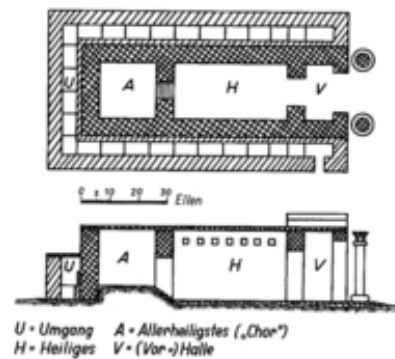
Grundriss und Rekonstruktion des Jerusalemer Tempels.
